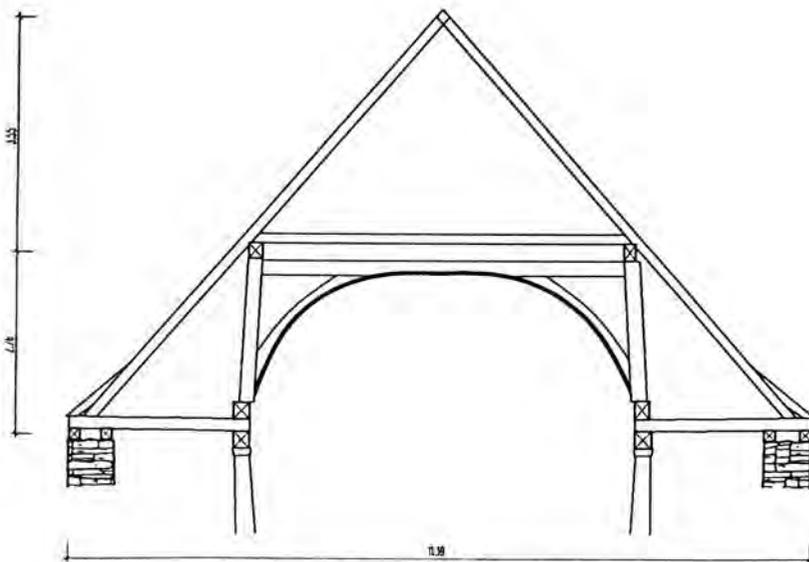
Kirche in Mansbach, Querschnitt der Dachkonstruktion mit Tonne, aus /40/
